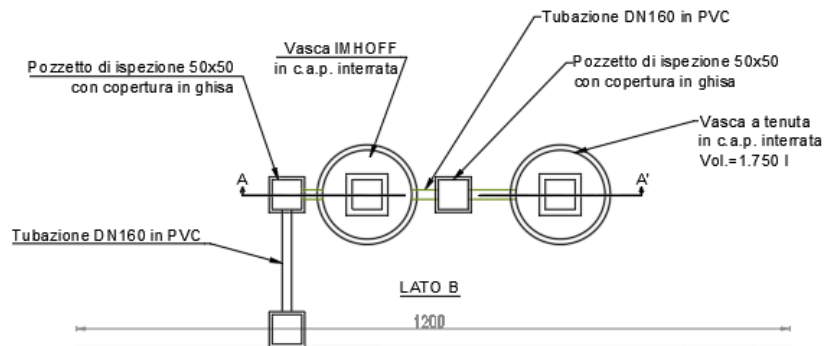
Planimetria Control room con sistema di accumulo acque nere
